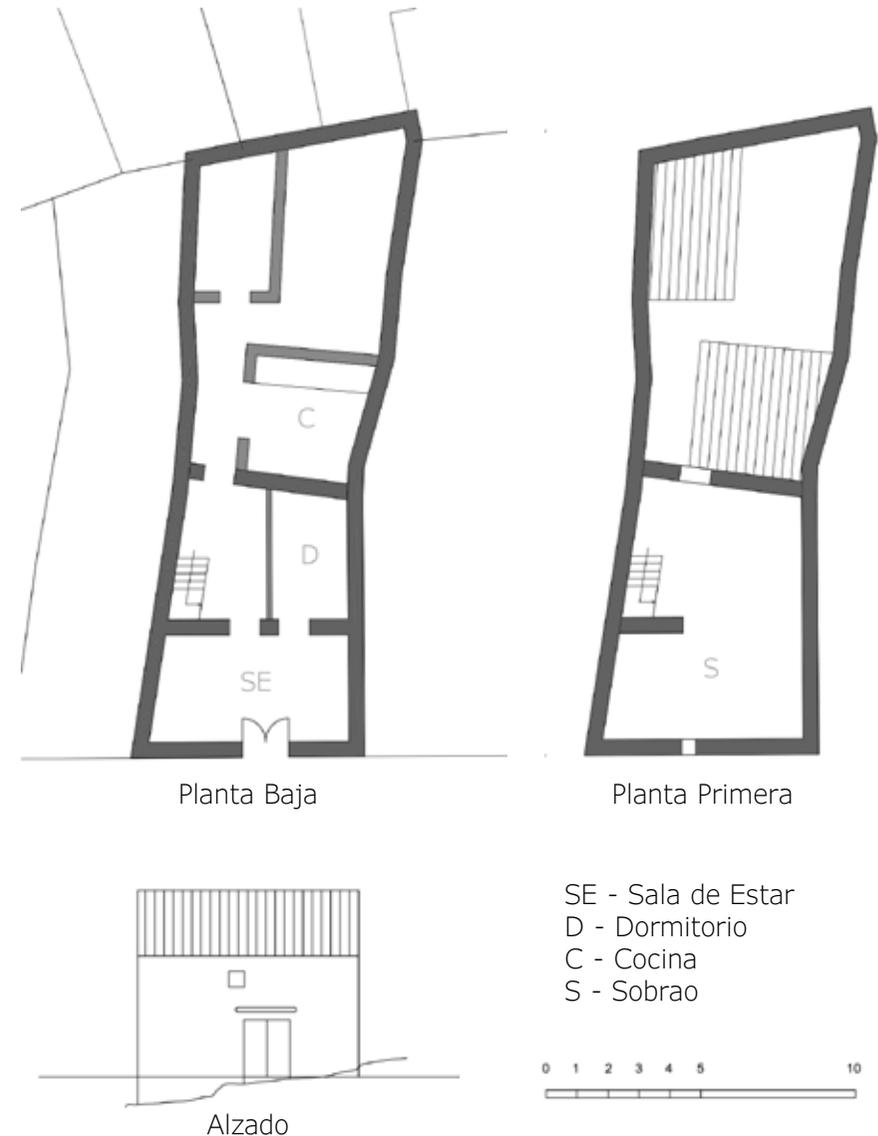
Planimetría actual de la vivienda seleccionada para el caso de estudio. Fuente de Autor.
